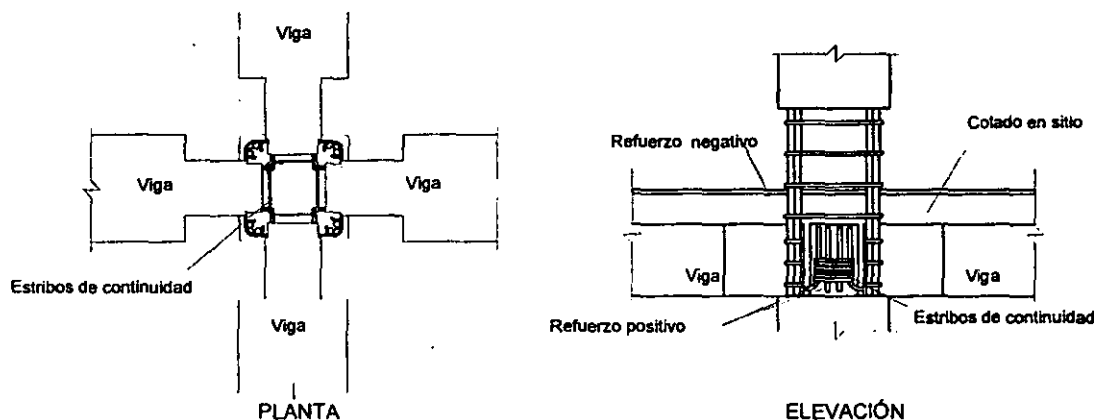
Conexión viga-columna propuesta por Carranza
